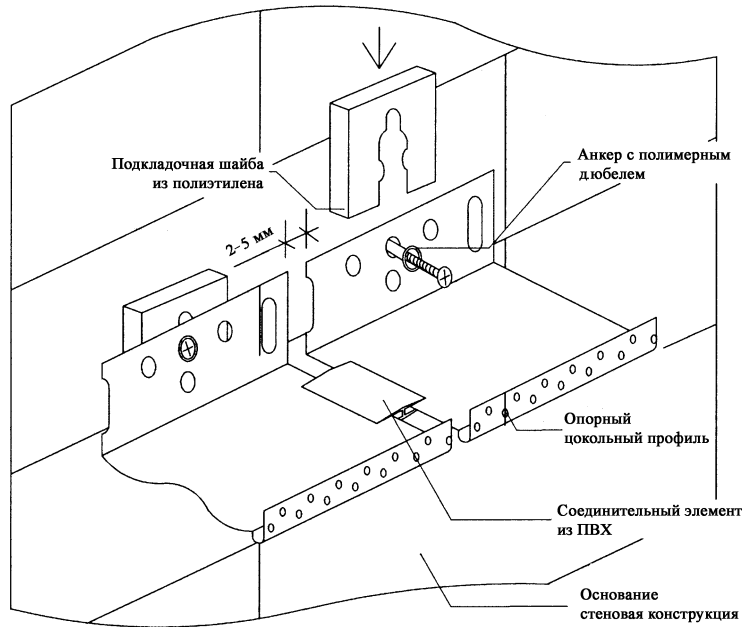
Схема монтажа опорного (цокольного) профиля
